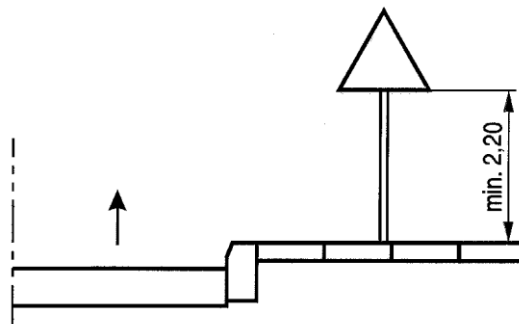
Odległość znaku od krawędzi jezdni na drodze
